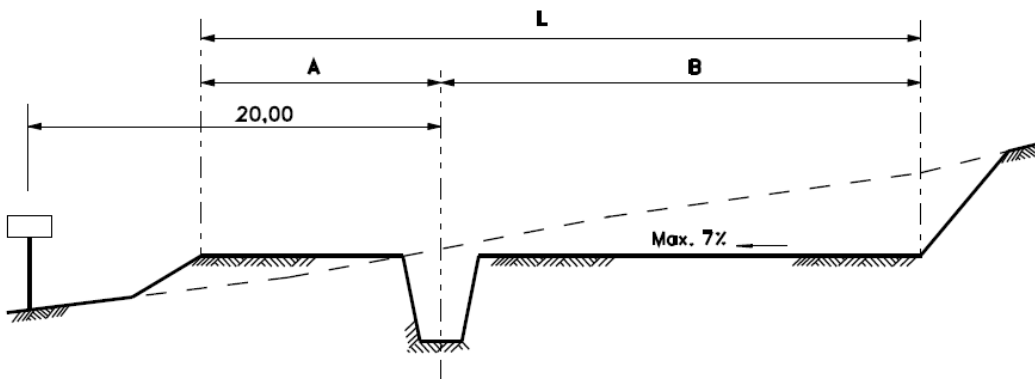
b: Cantiere di Linea Gasdotto, Tipologico di Pista di Lavoro Ristretta
